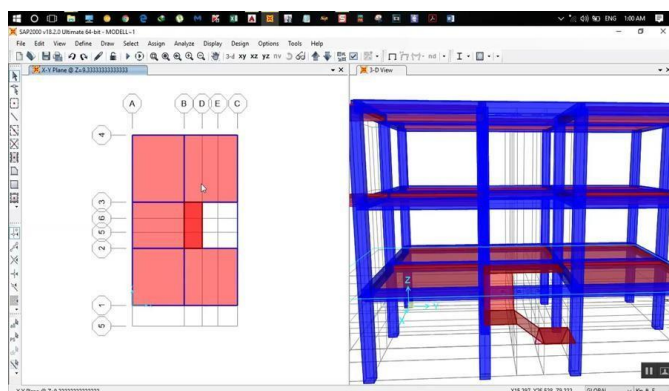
Interface de projeto em planta baixa e modelo 3D software SAP 2000
